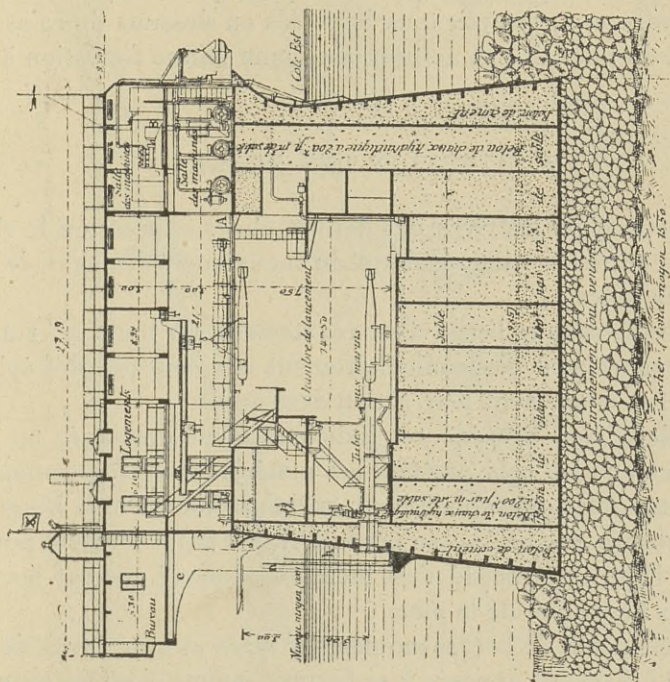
Coupe longitudinale de la batterie des Maures.
